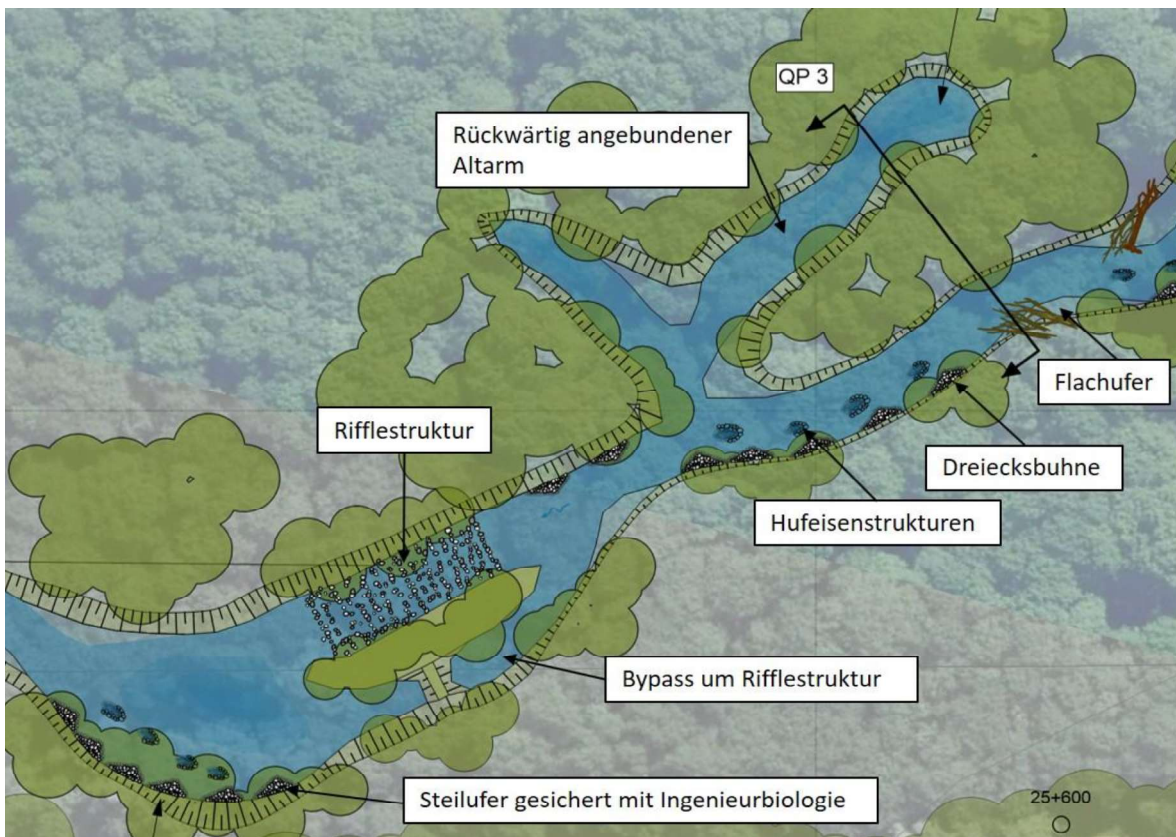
Ausschnitt aus dem Lageplan der Maßnahme 42 mit den wichtigsten vorgesehenen Strukturen.
